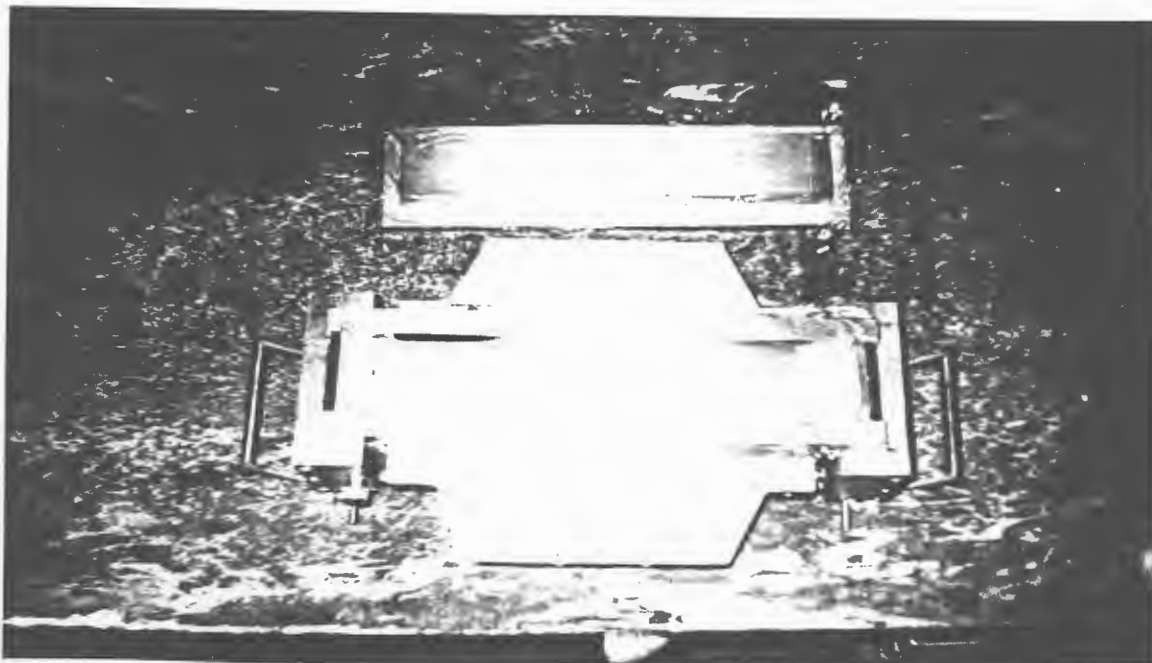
Forma especial de aço utilizada para moldagem das vigotas
